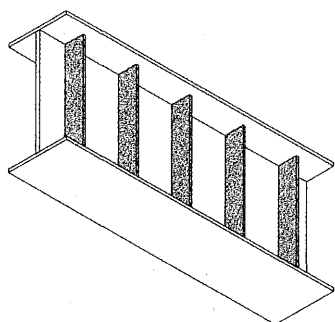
11. Refuerzos metálicos de vigas: refuerzos de almas con chapas.
